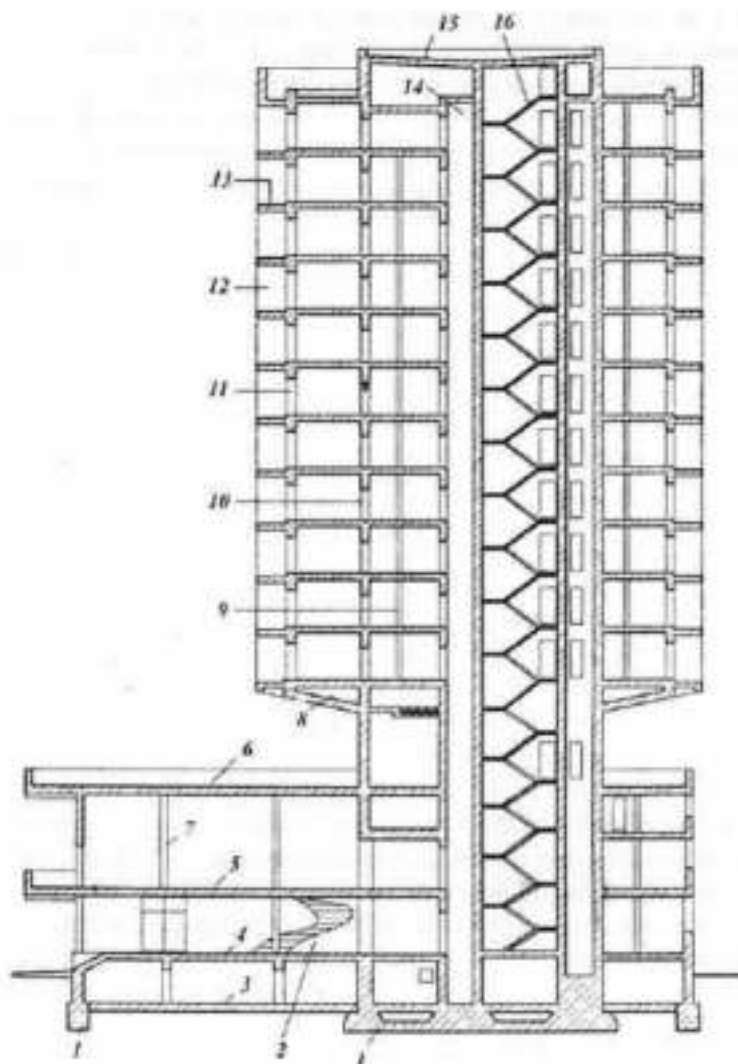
Будівельні конструкції багатопверхової будівлі готельно (розріз):
